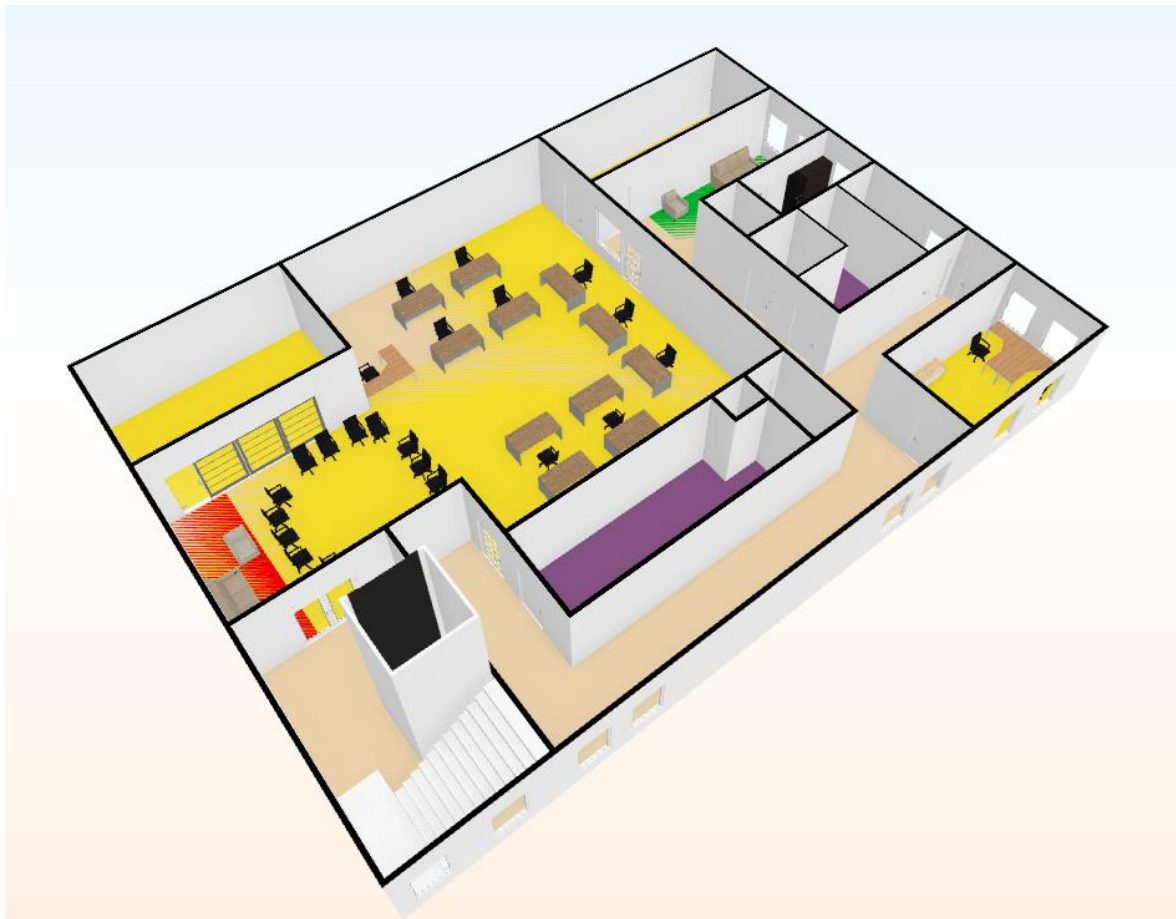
Darstellung des Hauptgeschosses (erstellt mit Floorplanner)
